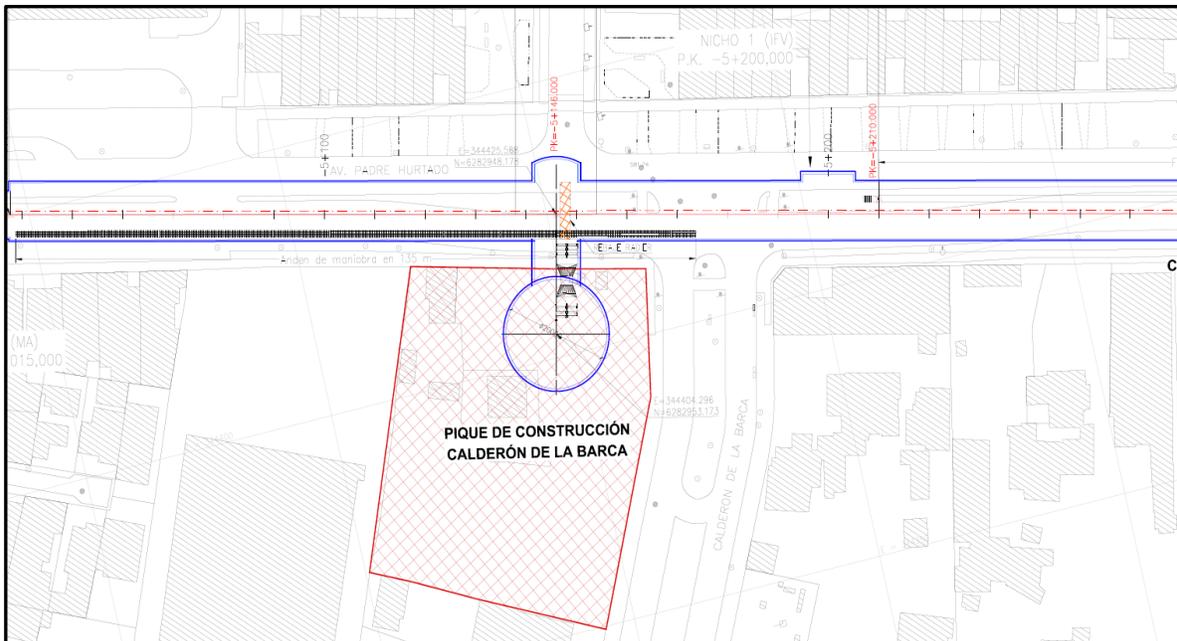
Planta Emplazamiento Pique Calderón de la Barca y Túneles Interestación
